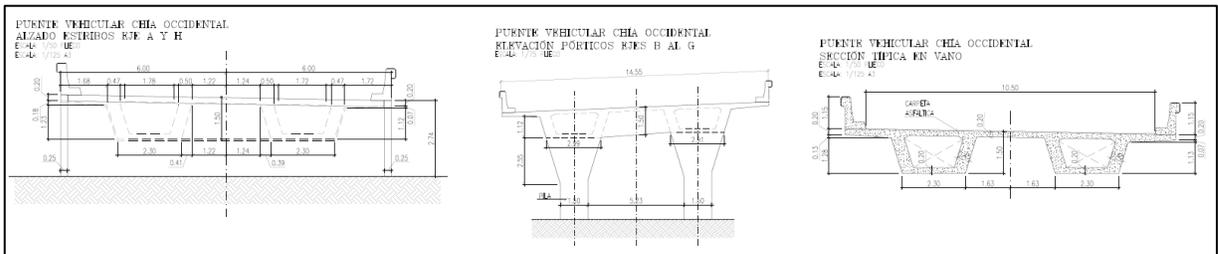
Vista General Puente Chía Occidental estribos y pilas
